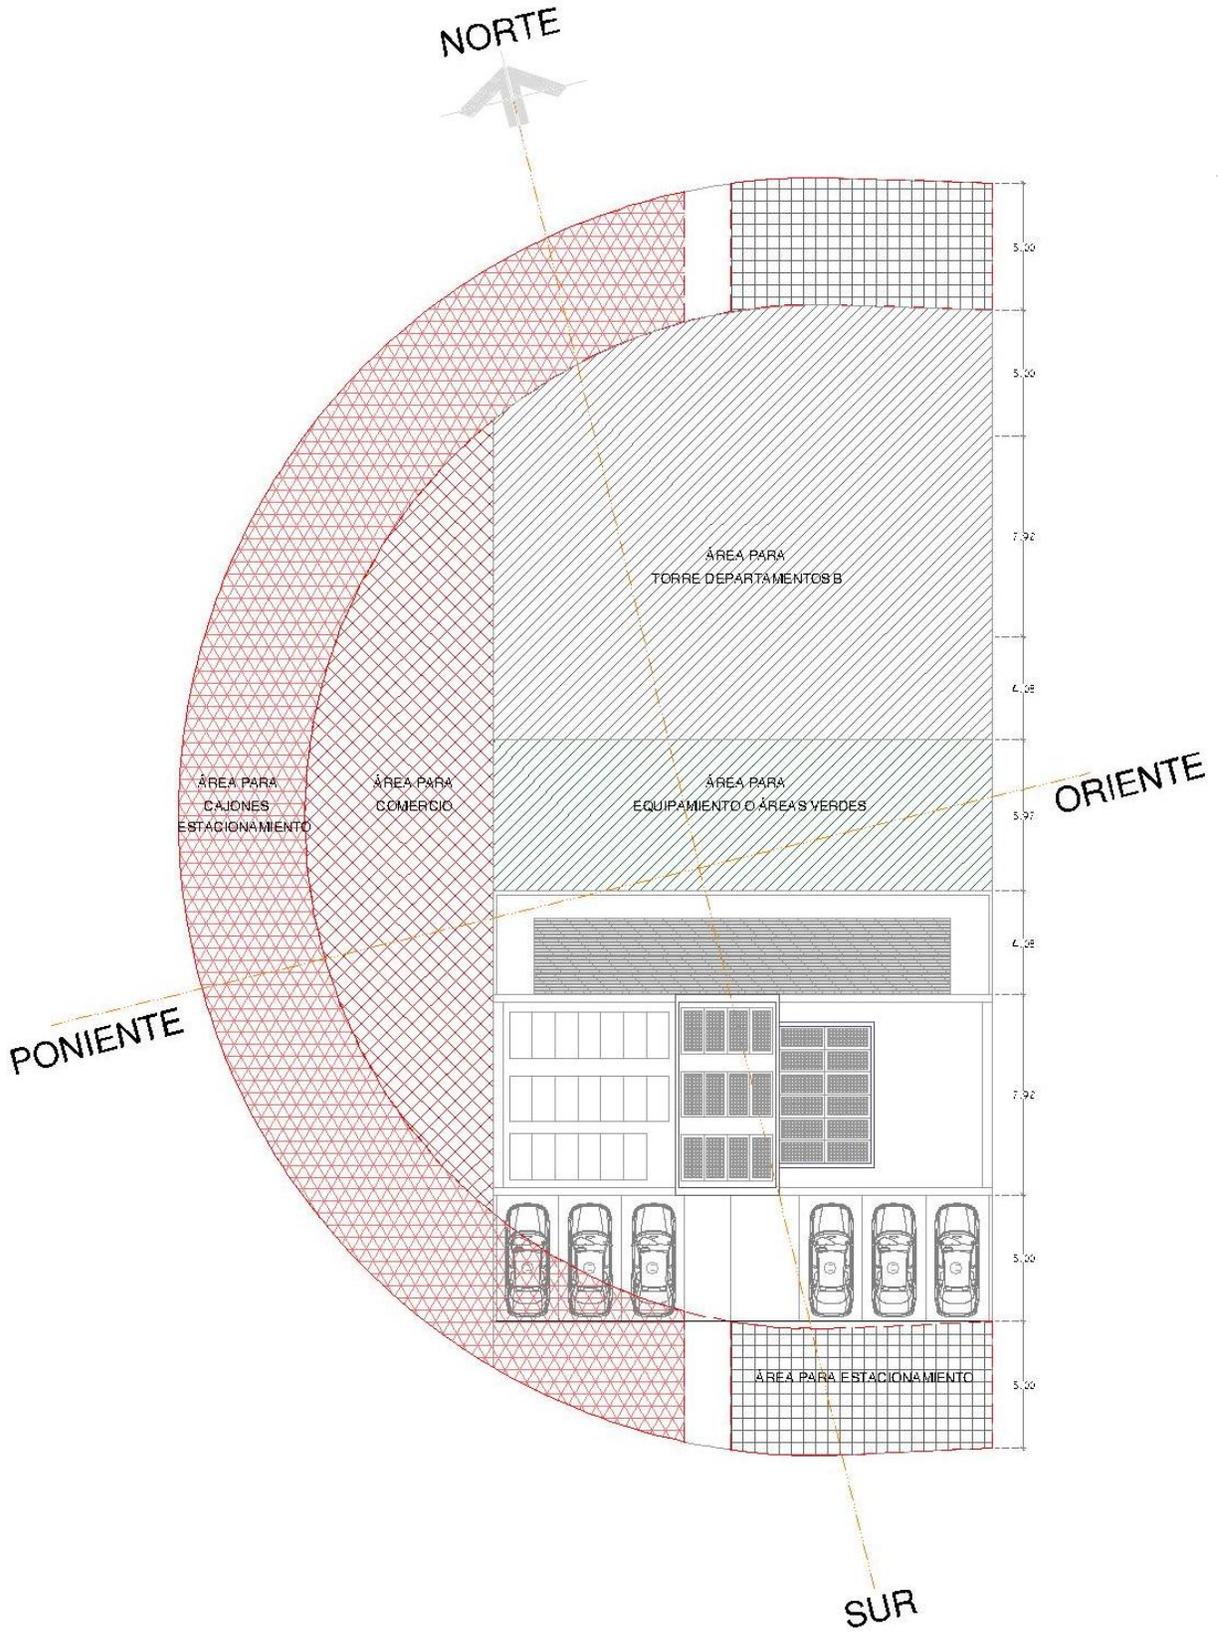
Planta de conjunto y zonificación Fuente: Elaboración propia
